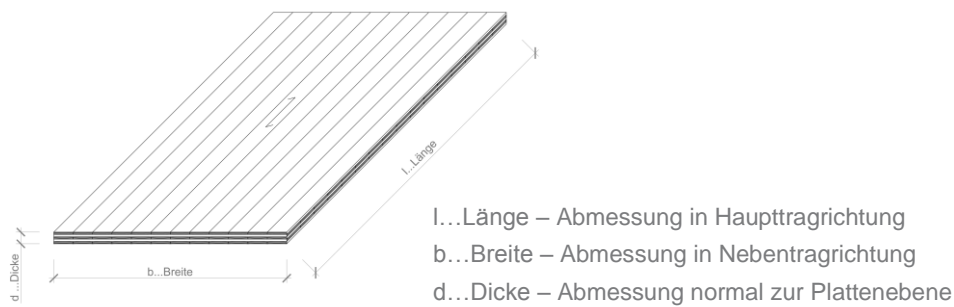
Brettsperrholzdecke – Abmessungen³⁹
